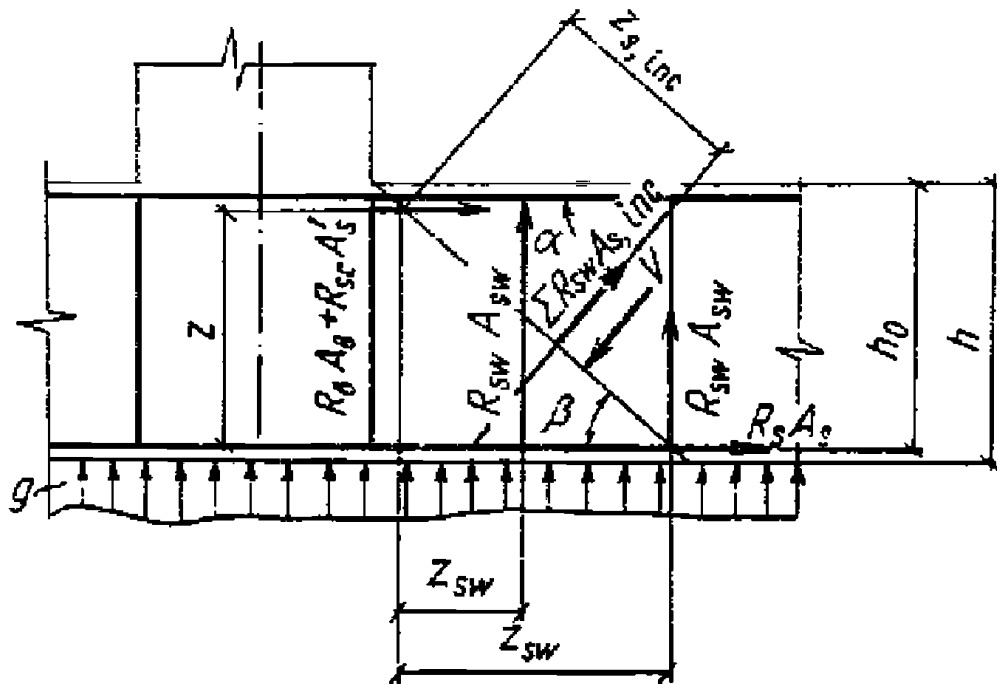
Схема усилий в сечении, наклонном к продольной оси железобетонного элемента, при расчете его по прочности на действие изгибающего момента
